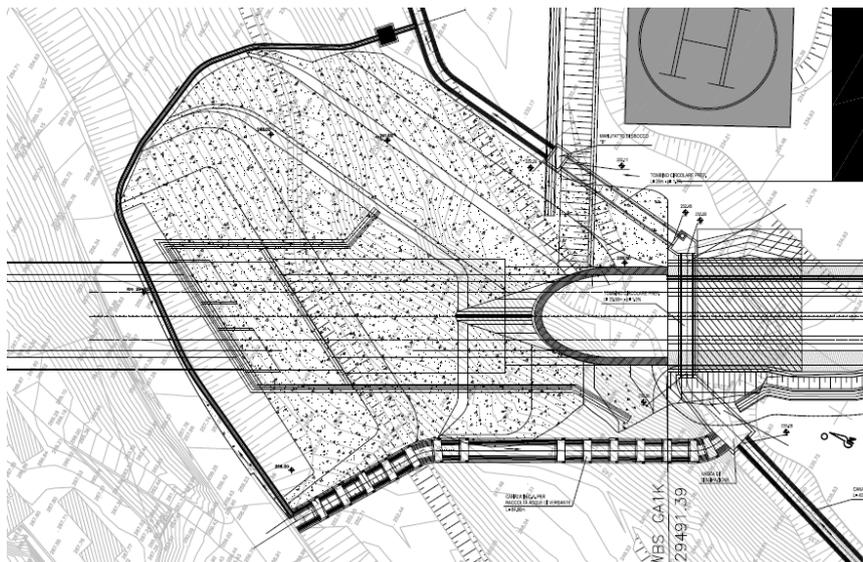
Planimetria GA1K0 – Imbocco Serravalle Sud
